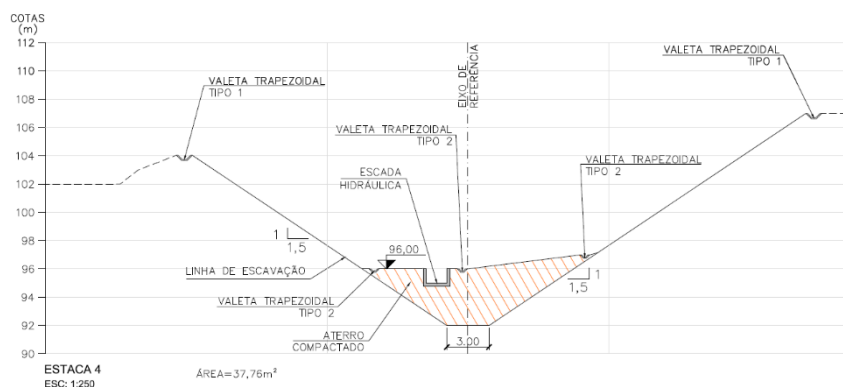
Secção transversal do canal, projeto de execução (BDM, 2017)
